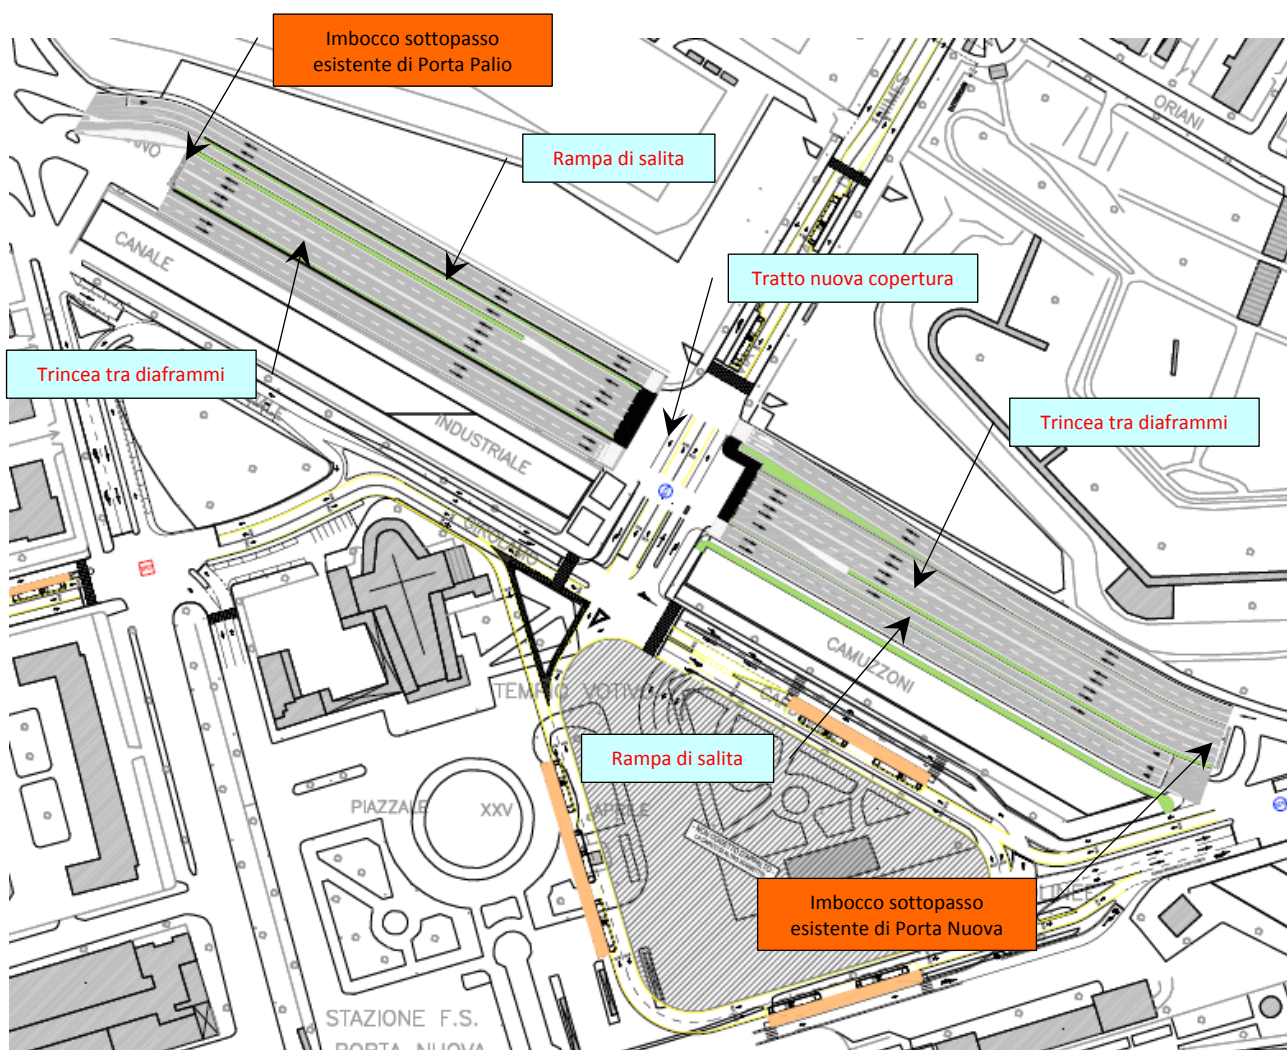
planimetria di progetto del sottopasso di via Città di Nimes
